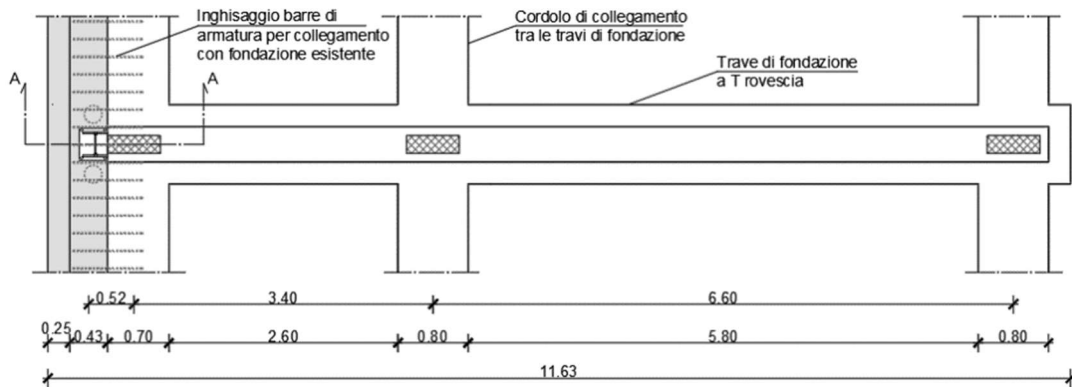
Rappresentazione in pianta dell'intervento di rinforzo delle fondazioni.
